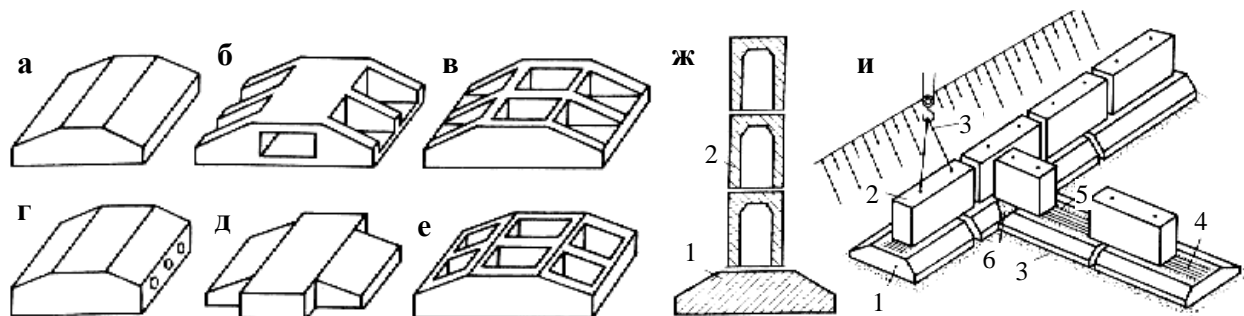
Збірні стрічкові фундаменти: а – суцільні фундаментні плити; б, в – ребровані; г – порожнисті; д – з вирізами; е – з кесонними пустотами; ж – стіна з порожнистих блоків; и – монтаж збірних стрічкових фундаментів; 1 – фундаментний блок; 2 – стінний блок; 3 – піщана підготовка; 4 – армований пояс; 5 – постіль з розчину; 6 – закладення монолітним бетоном; 7 – строп
